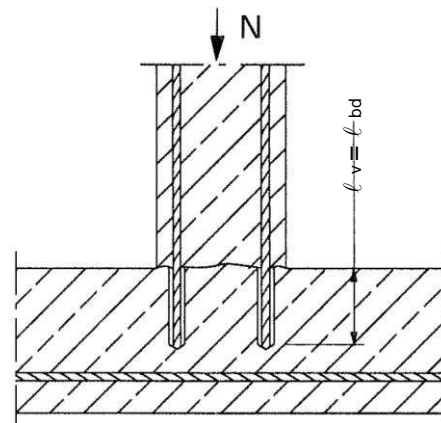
Recouvrement d'armatures à la fondation d'un mur ou d'une colonne avec armatures sous contrainte de traction
